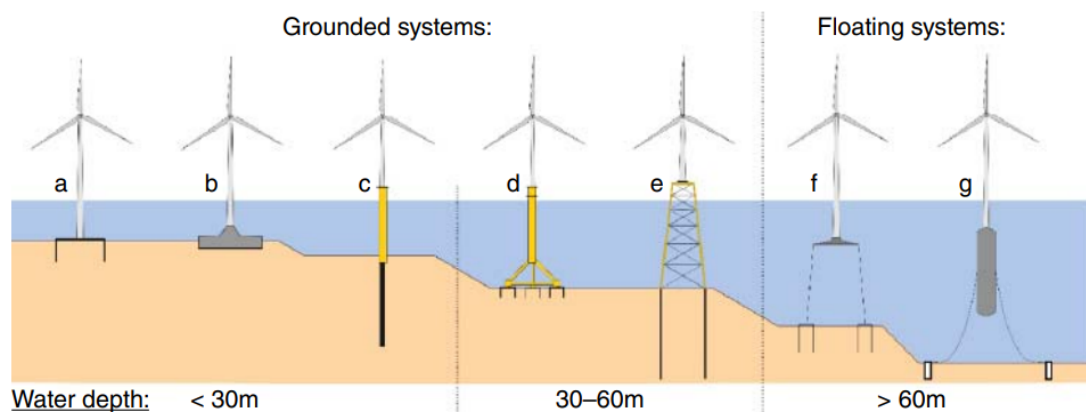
Type de fondations selon les profondeurs [3]
